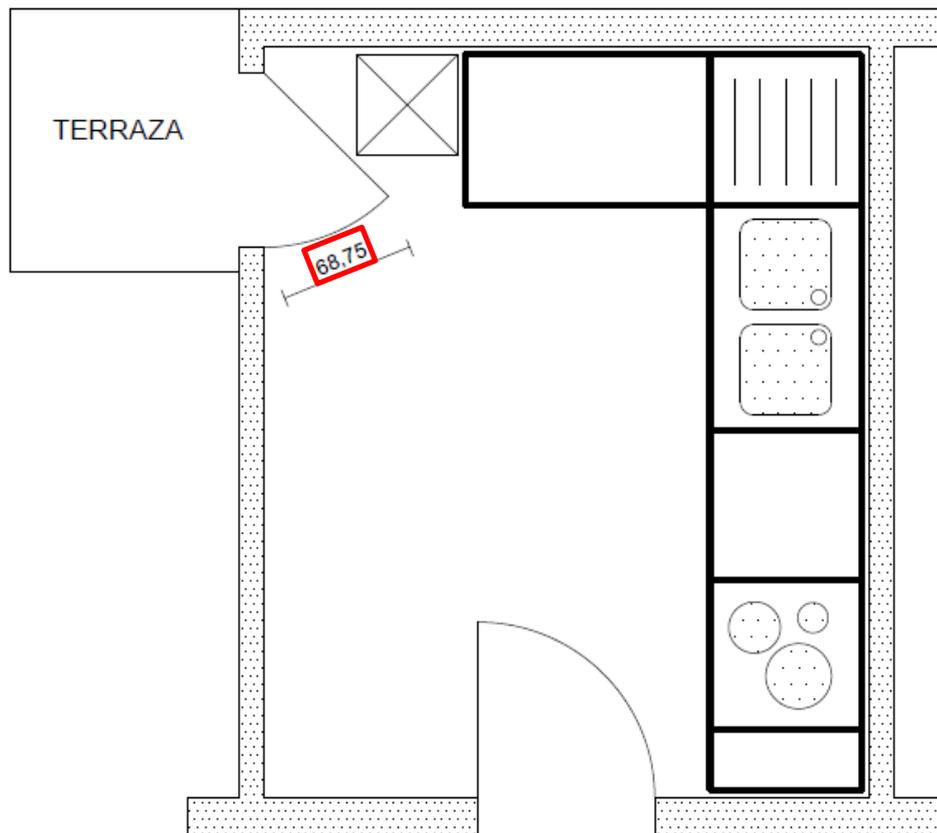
Contenedor obstaculizando apertura de una puerta. Planta. (Elaboración propia)
